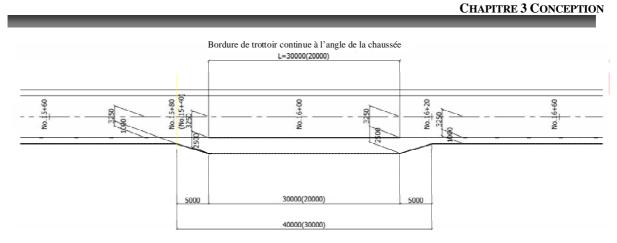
Plan de la voie auxiliaire d'arrêt d'autobus
